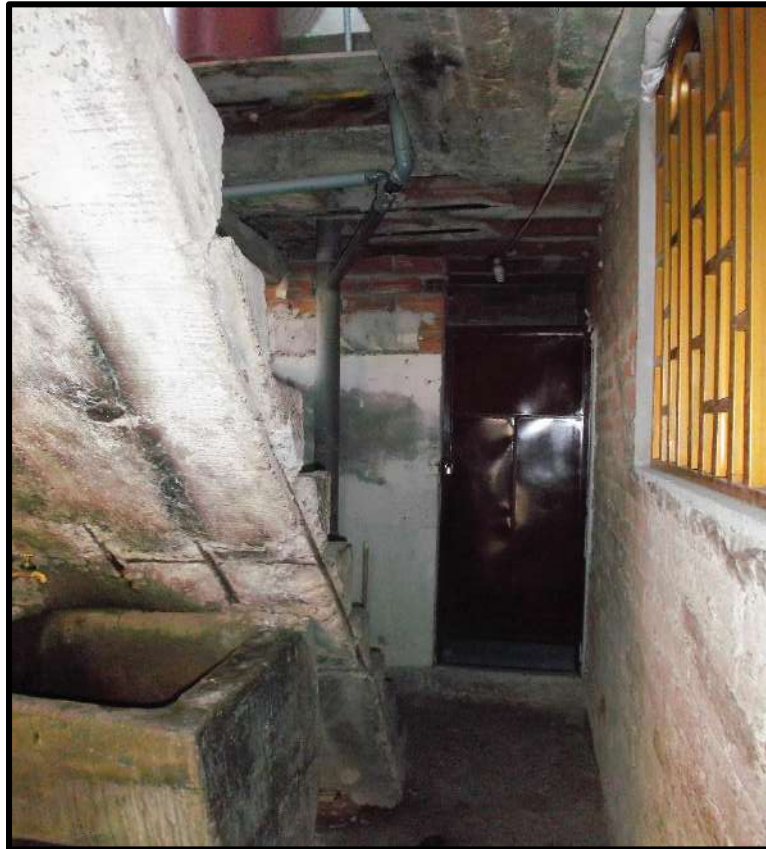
Escalera en mal estado y acero de viguetas expuestas.
